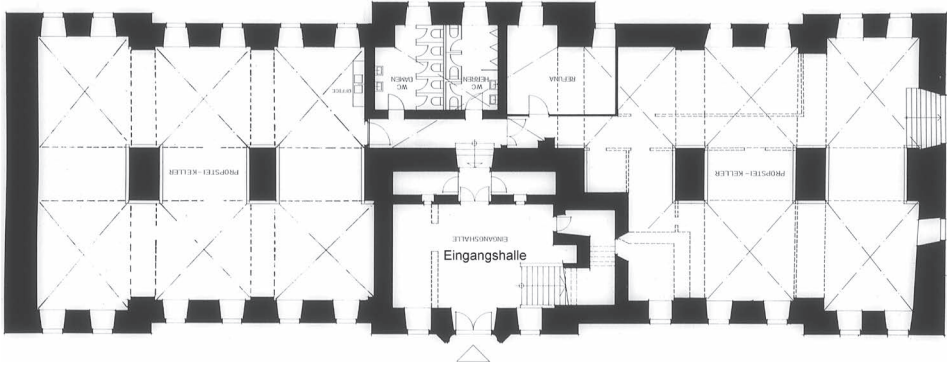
Propstei in Klingnau, Grundriss des EG
